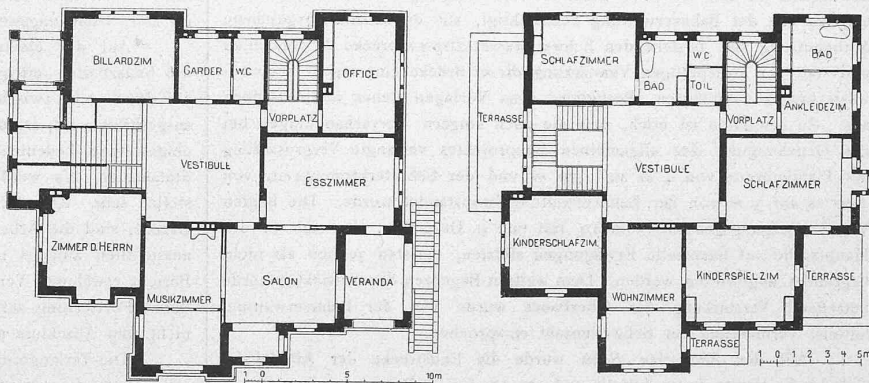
Grundrisse vom Erdgeschoss und ersten Obergeschoss der Villa Hagmann. — 1 : 400.
